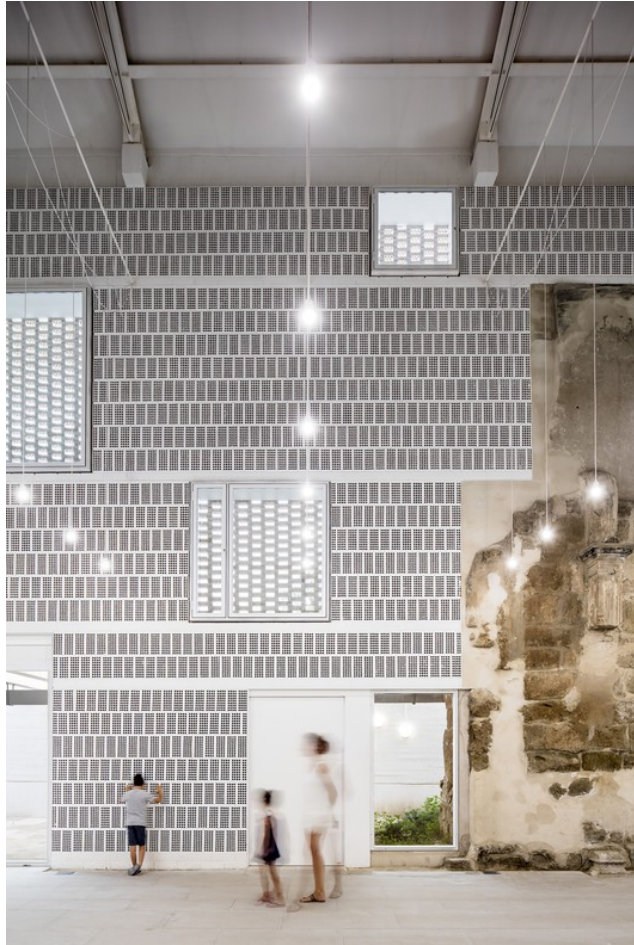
Reestruturação alvenarias - - Santa María de Vilanova de la Barca.
